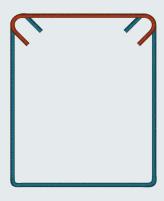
Estribo de dos piezas aceptable para encamisado de vigas de concreto. Fuente: elaboración propia.
